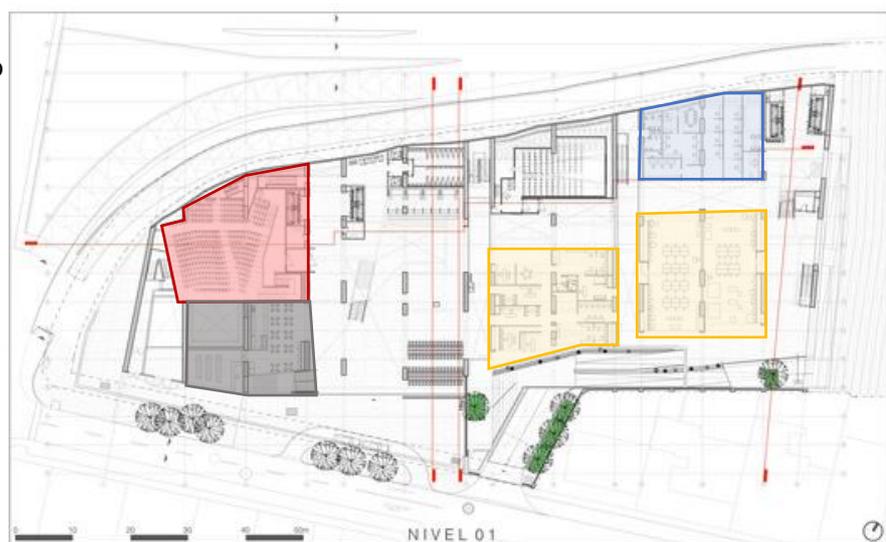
Planta General - Universidad de Ingeniería y Tecnología
